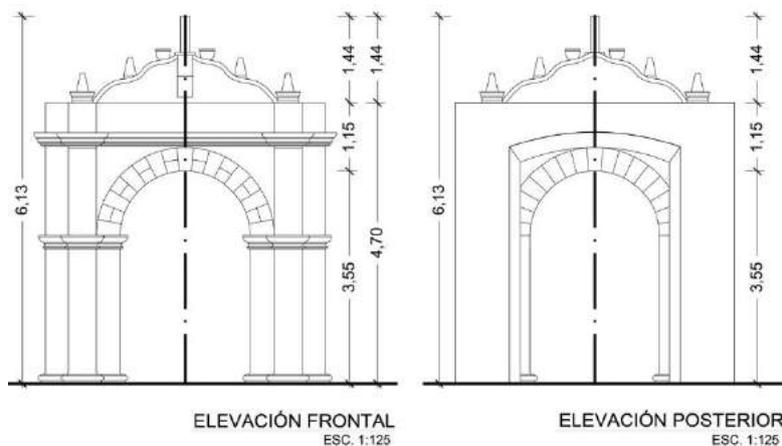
Planos de elevaciones de la puerta-umbral noreste. Elaboración propia.
